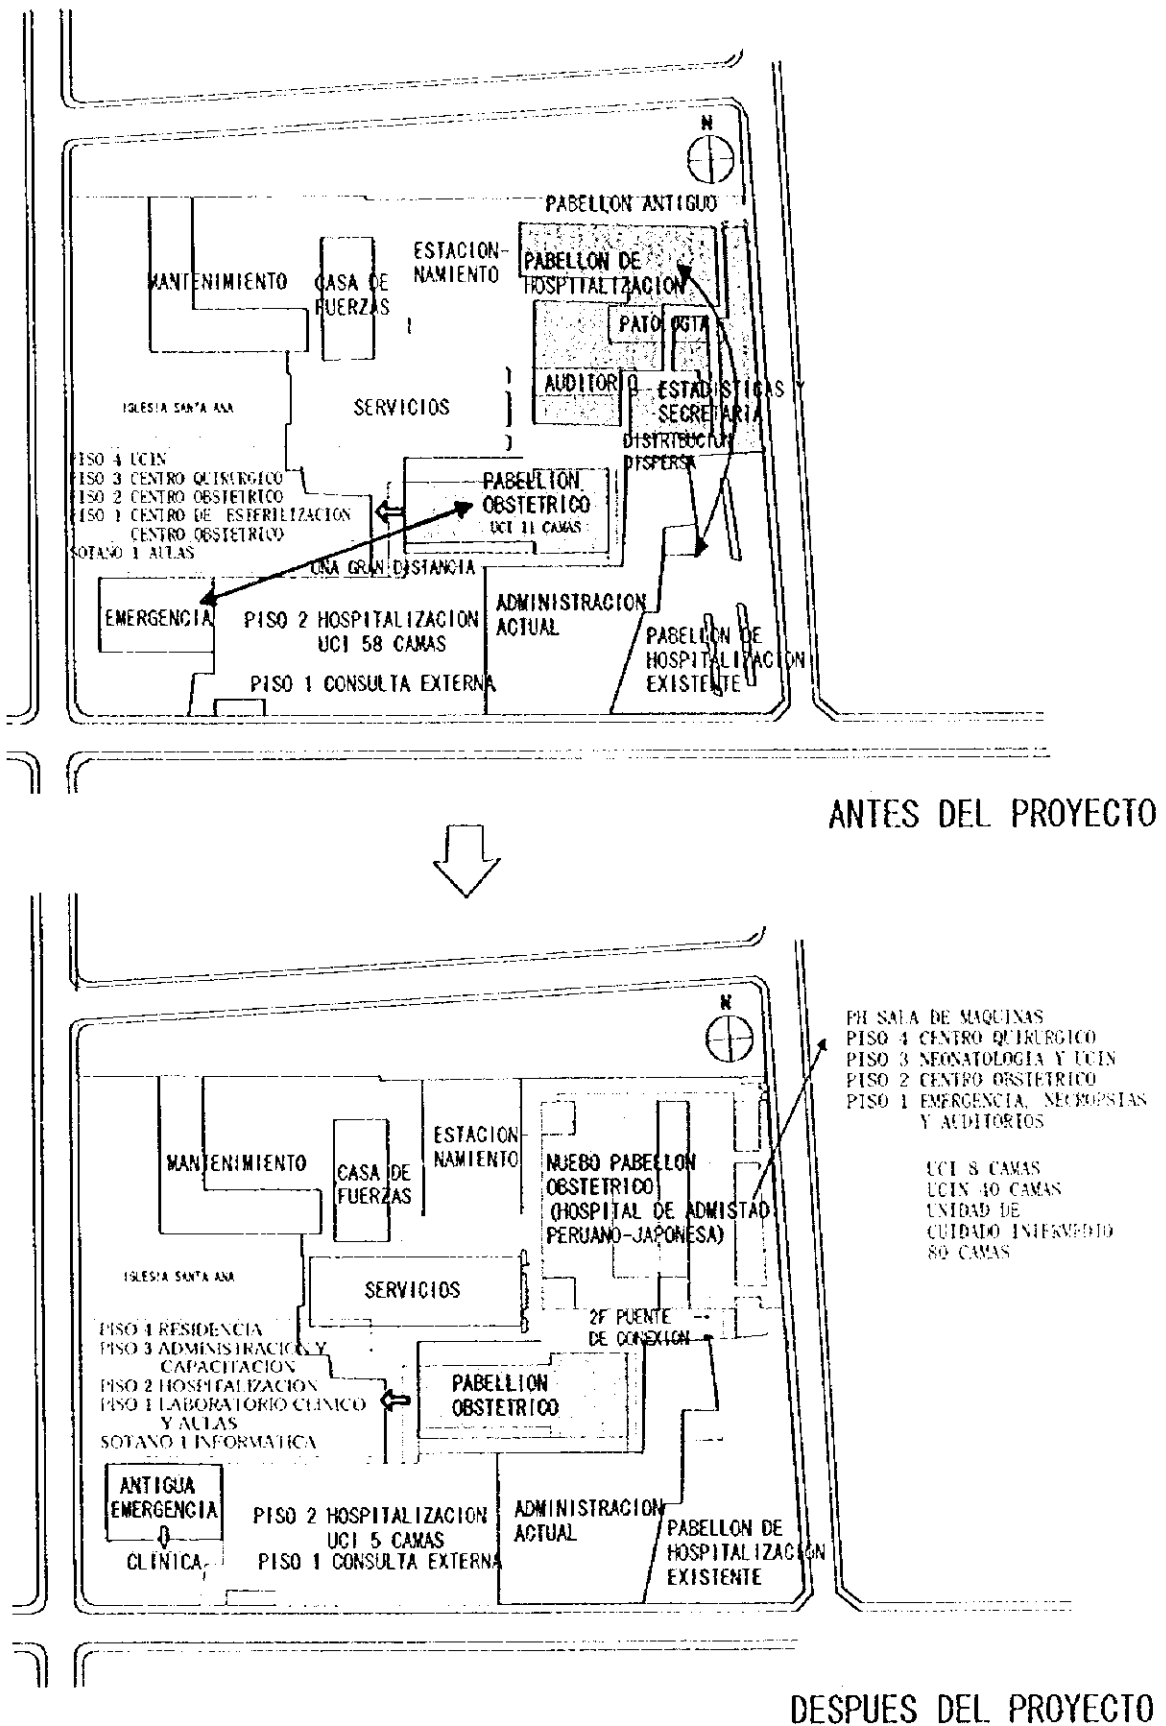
Distribución de las infraestructuras antes y después del Proyecto
